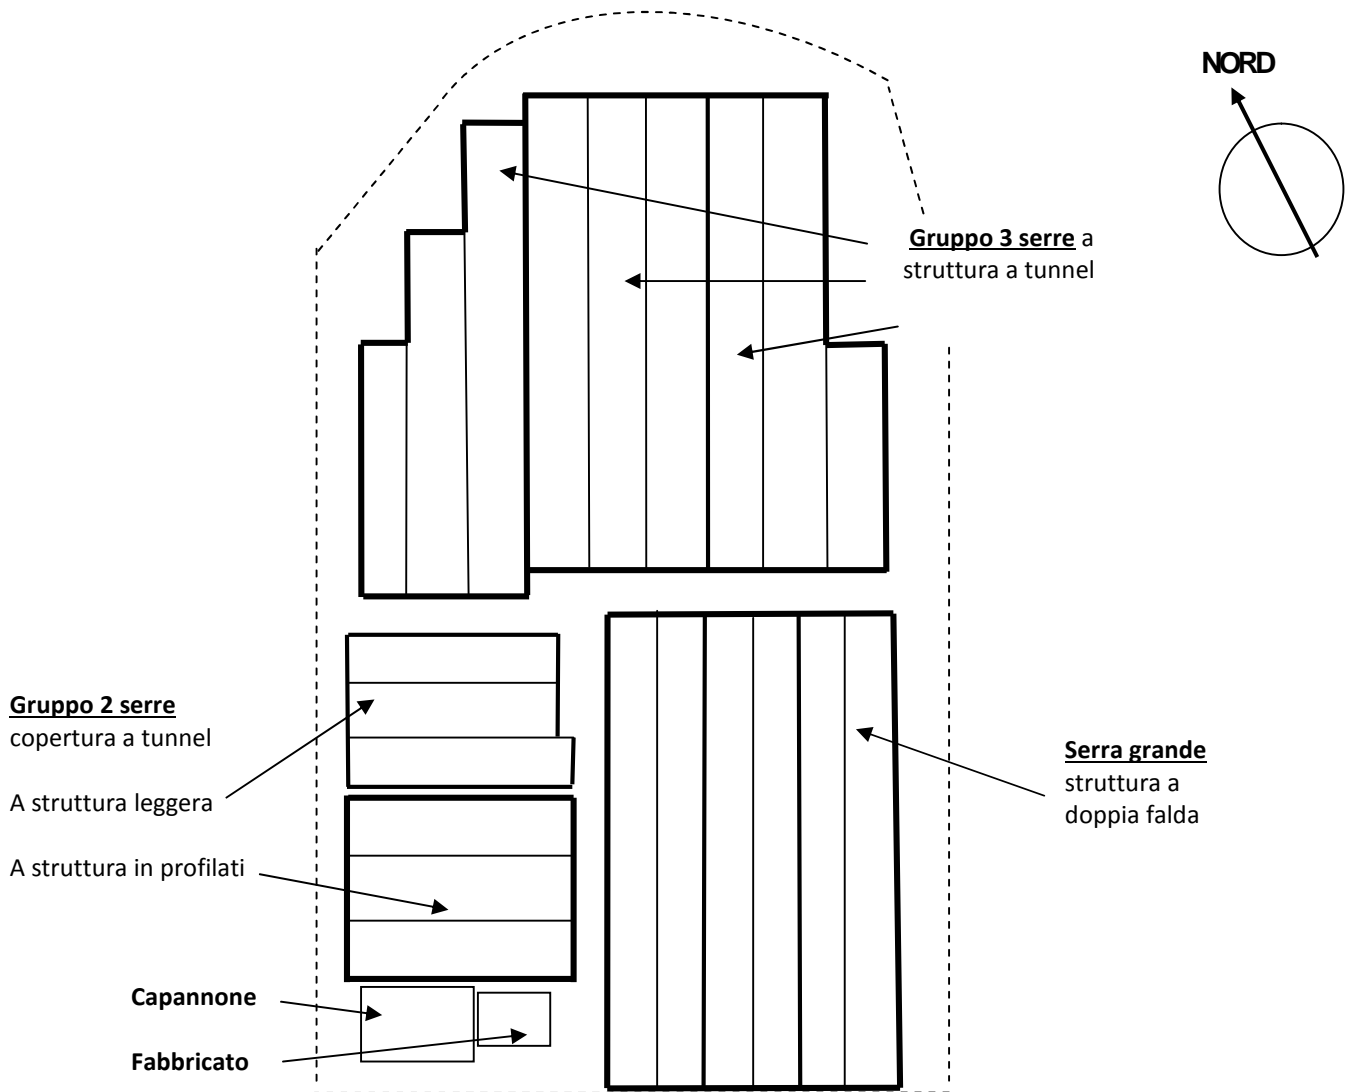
Planimetria posizionamento serre. Circa scala 1:2000
